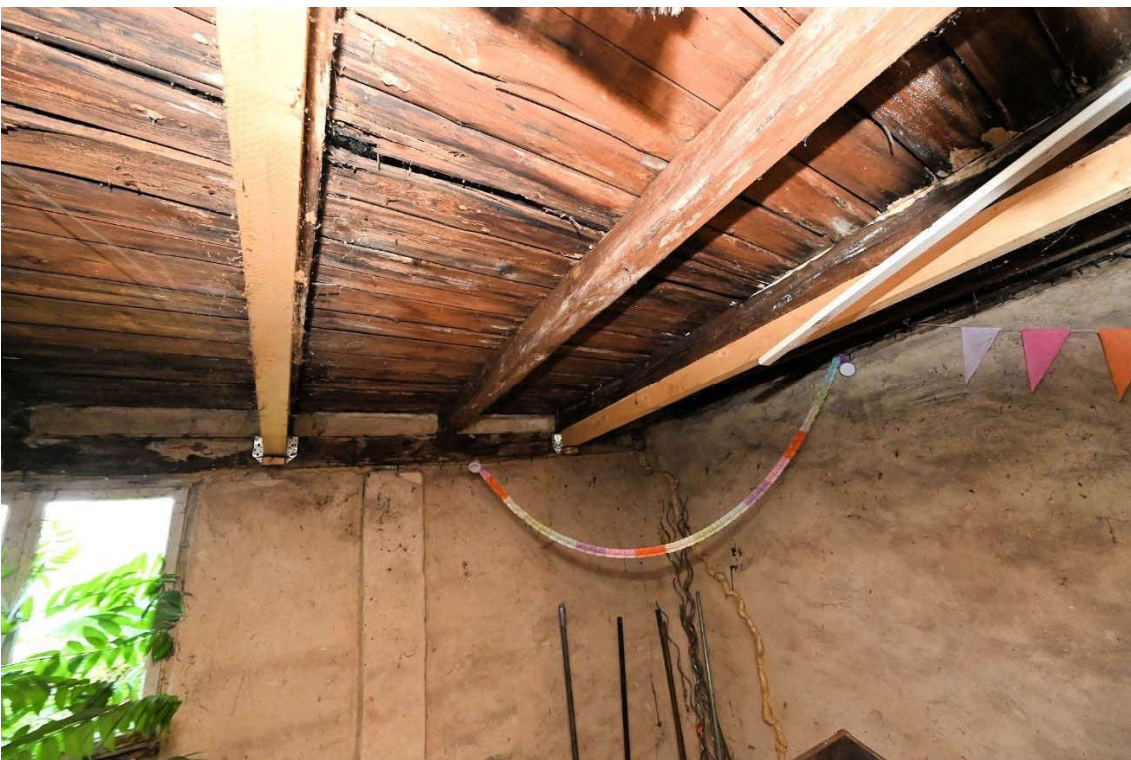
Nebengebäude C, Erdgeschoss, Detail Nässeschäden
